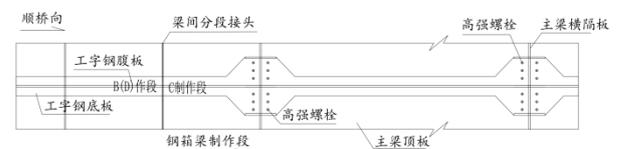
C 钢箱梁制作段与 B、D 钢箱梁制作段拼装平面图
